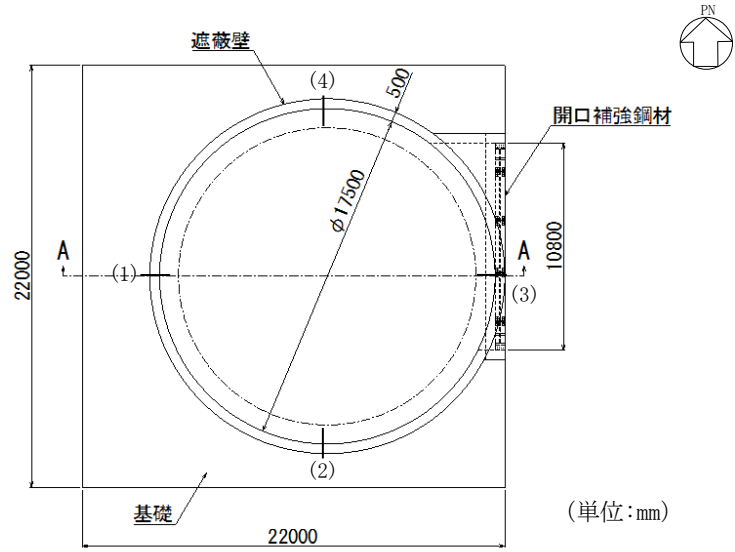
復水貯蔵タンク遮蔽壁 平面図
